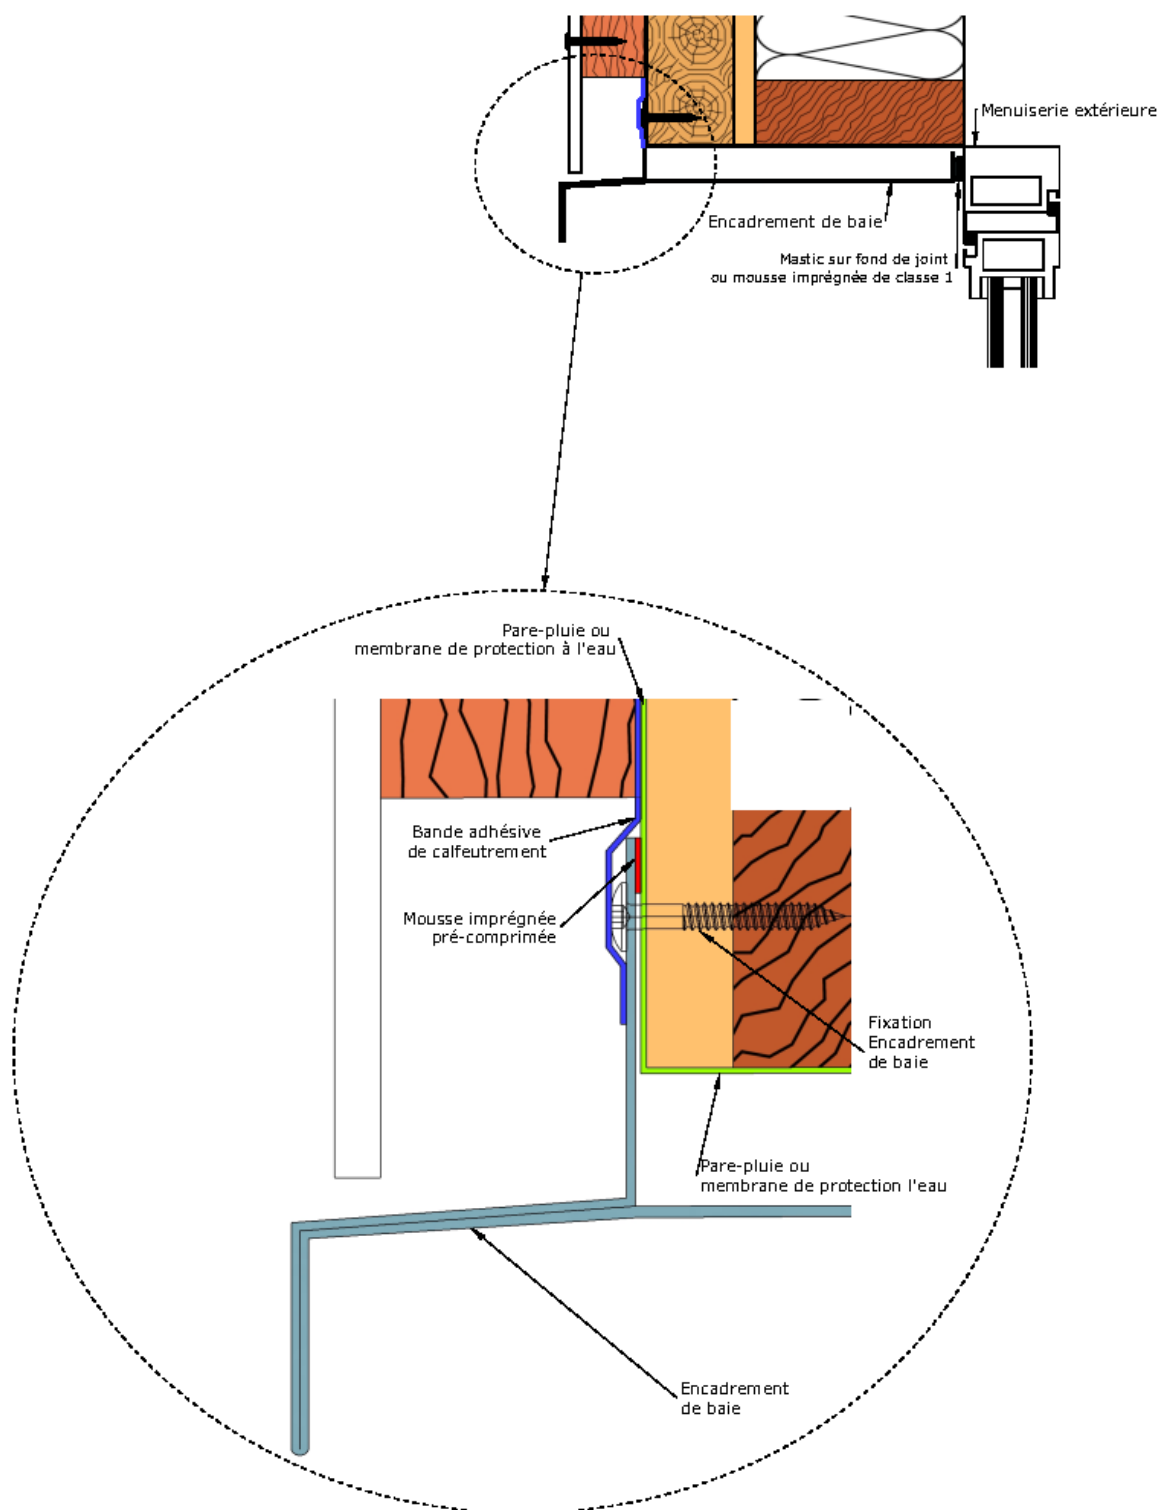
Liaison pare-pluie ou membrane de protection à l'eau avec encadrement de baie monobloc soudé 4 cotés acier 15/10e, Ee2, coupe verticale linteau
